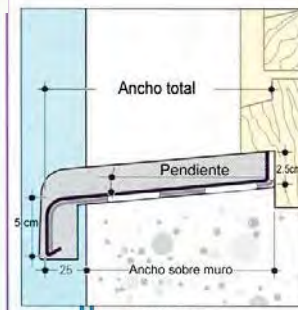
REPISÓN BAJO VENTANA DE CONCRETO APARENTE ACABADO LISO CON COLOR
